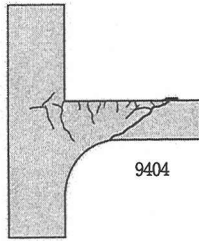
TYPE-II ③試験体のひび割れ発生状況
